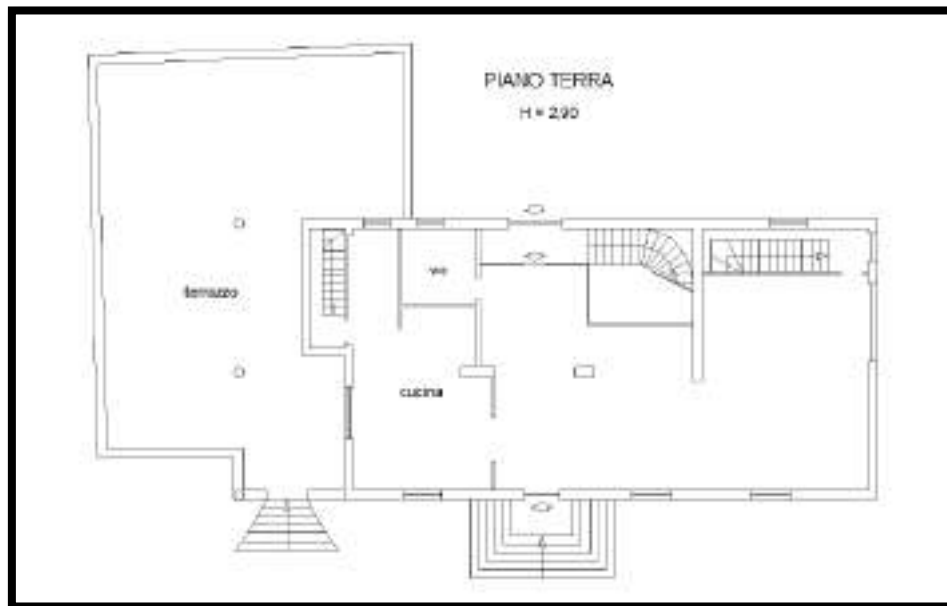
Planimetria catastale piano terra identificato con il sub 8
